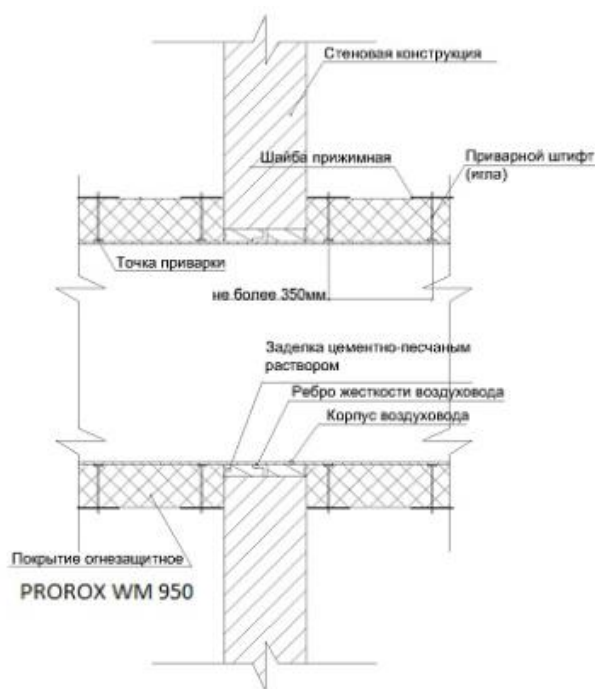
Принципиальная схема пересечения воздуховодом строительной конструкции.
